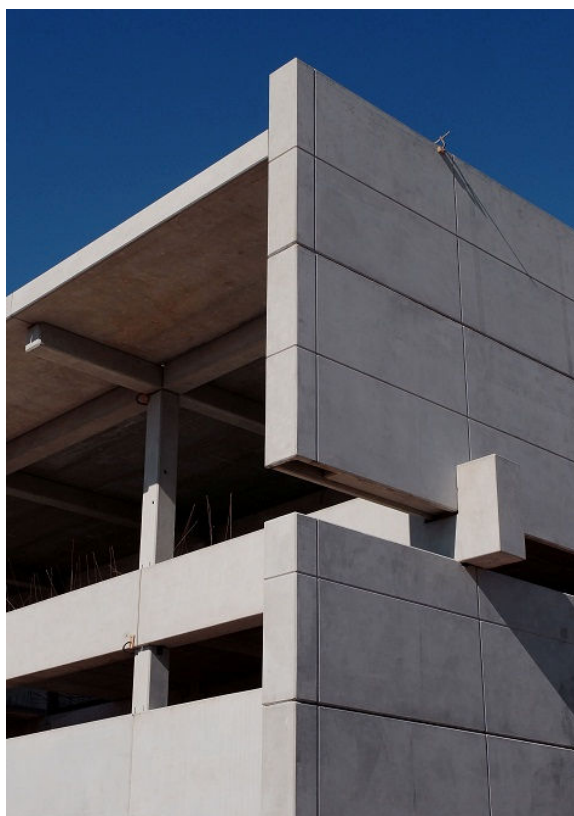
Edifício com Painéis pré-fabricados de betão com face-à-vista (Empresa Concremat, 2011)
